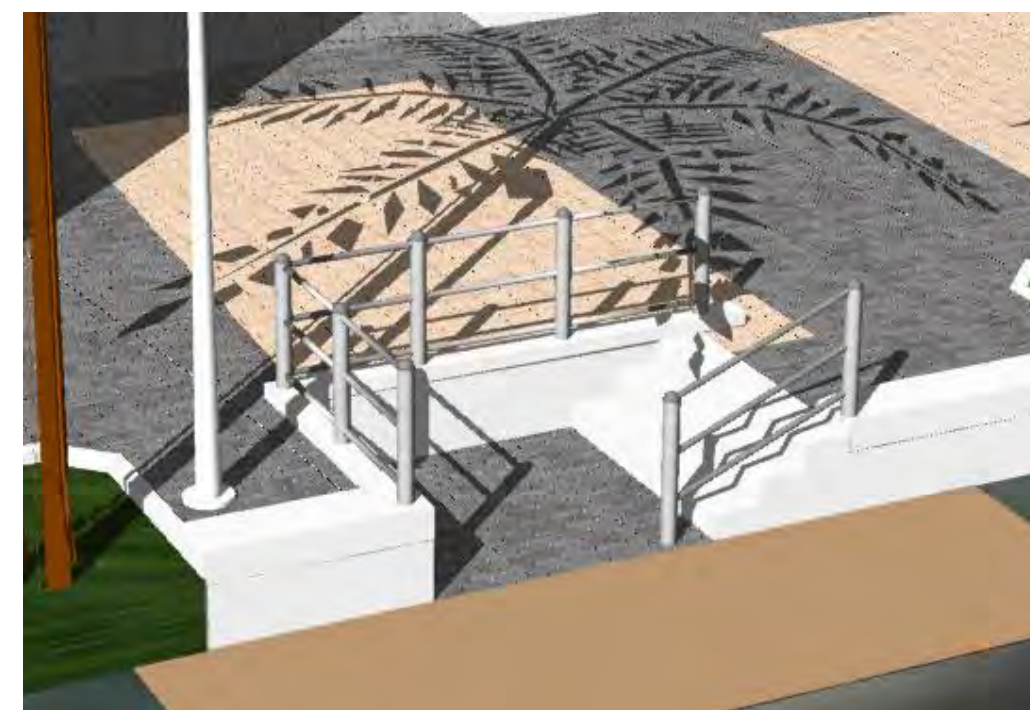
D Detalle muro contención, elevación para bancos y encuentro con jardineras
